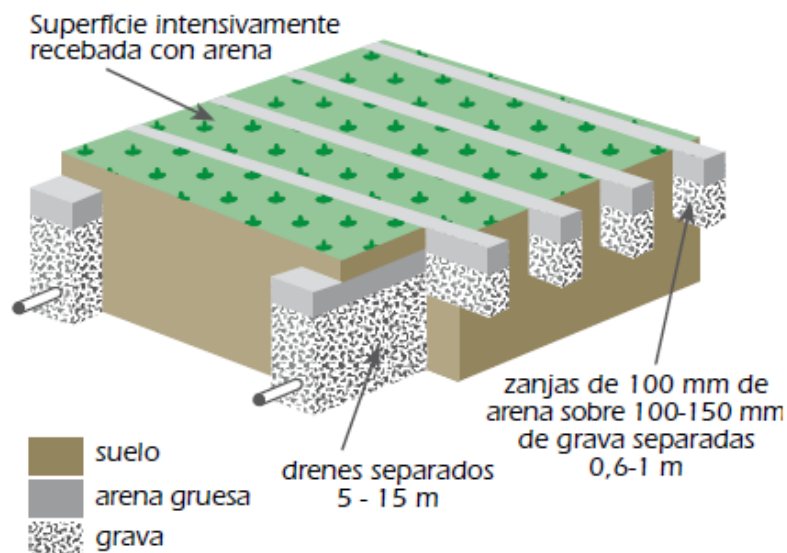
Detalle de un sistema de drenaje tipo *slitdrain*.
